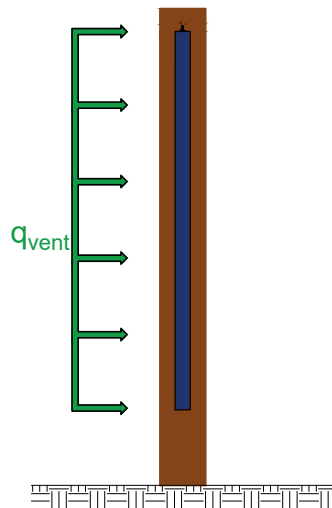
Charge de vent sur les panneaux verticaux.
